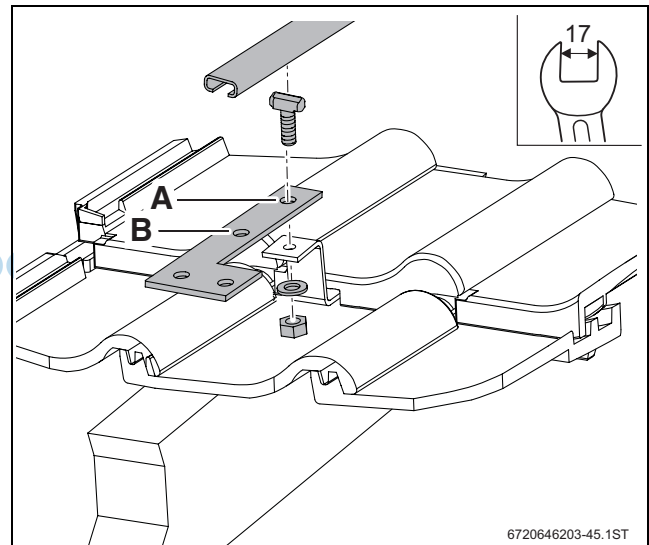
Schienen mit L-Verbinder und Haltebügel verschrauben (hier: an Position A)
